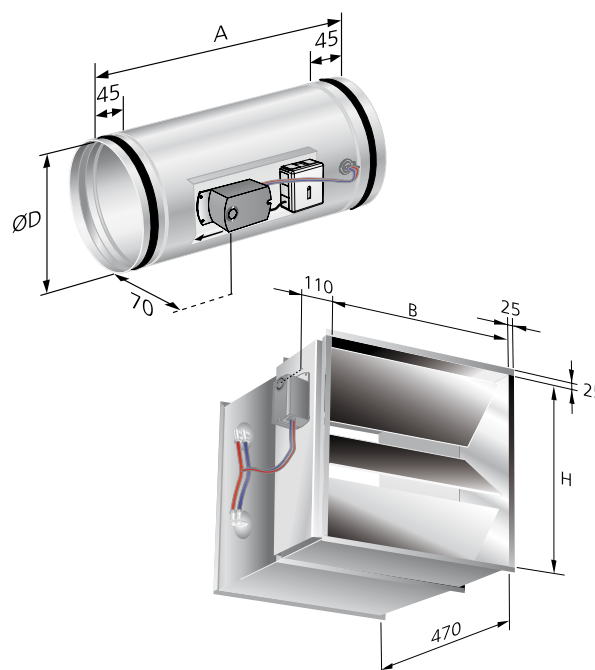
SLAVE Control для воздуховодов круглого или прямоугольного сечения
